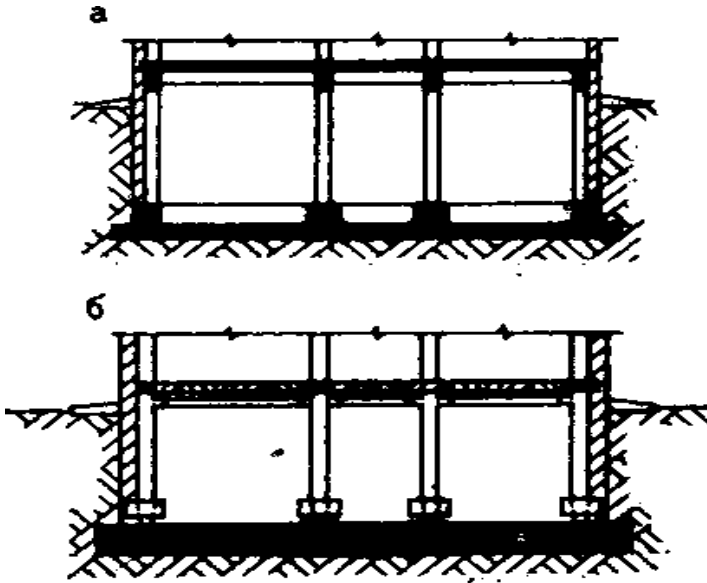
Суцільні плитні фундаменти: а - у виді ребристої залізобетонної плити; б - у виді суцільної залізобетонної плити
